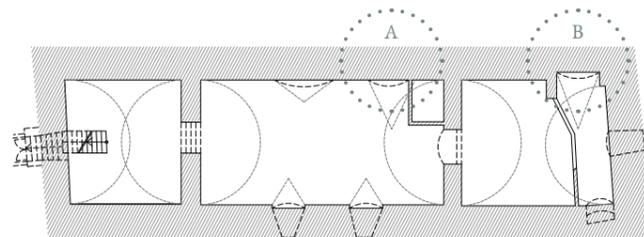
Lage möglicher Zugänge zum Brunnen, Grundriss Kellergeschoß
